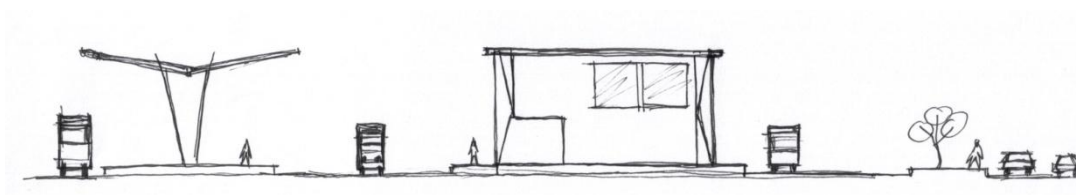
Croqui do estudo de intervenção da Praça João XXIII.
